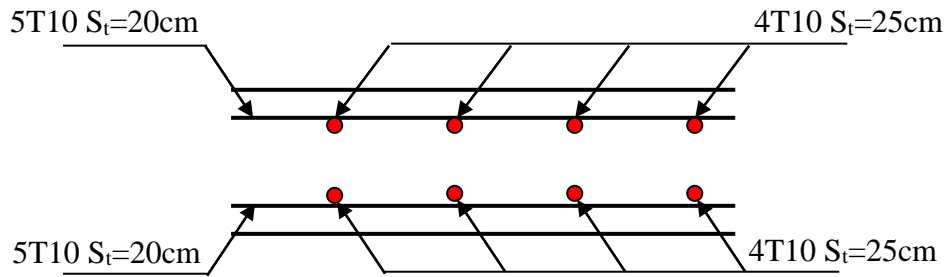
Vue en coupe du ferrailage de la dalle.
